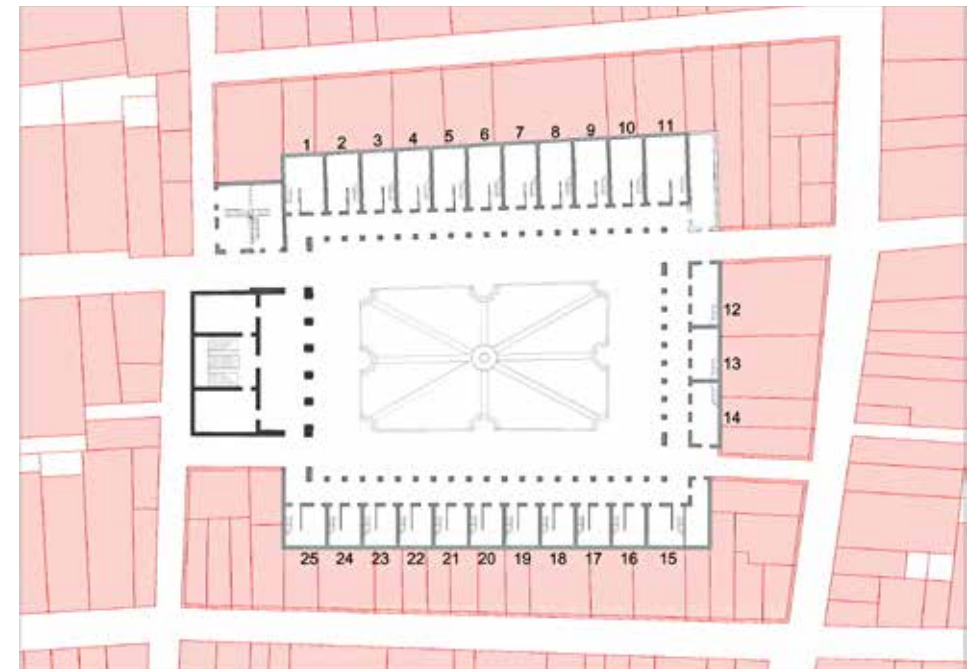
Reconstitución hipotética por el autor de la planta baja y de la planta tipo del conjunto edificado de la Plaza Nueva de Hércules Torelli..
